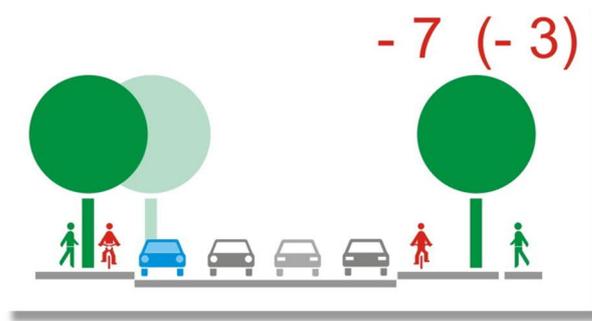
Abschnitt B1 – Baumbilanz (Klammerwert: mit Grunderwerb)
